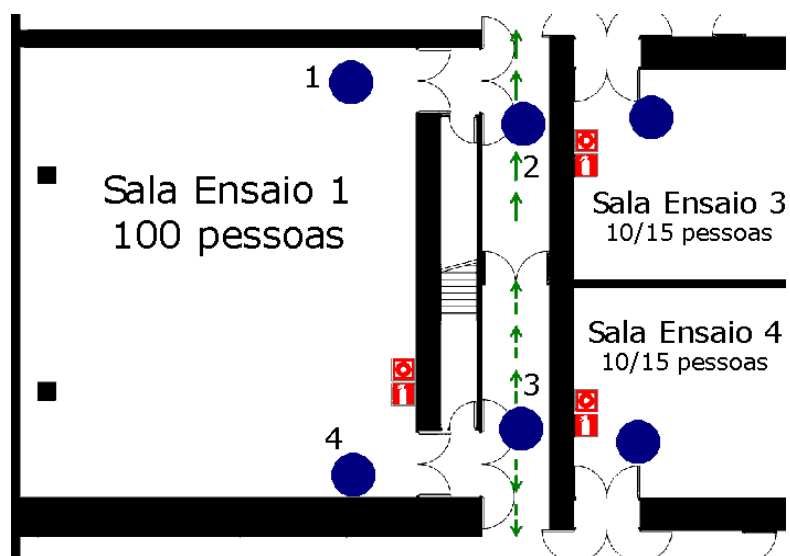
Evacuação das Salas de Ensaio 1 – 1º Passo
